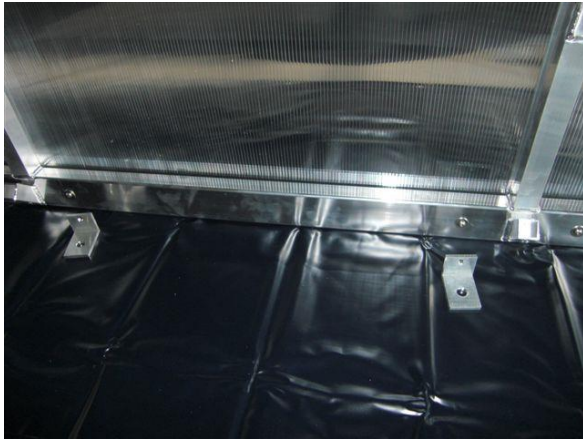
Rückwand aufrichten. Zwei beliebige der bereits werkseitig vormontierten Linsenkopfschrauben zur Befestigung der Bodenverankerungen auswählen.
